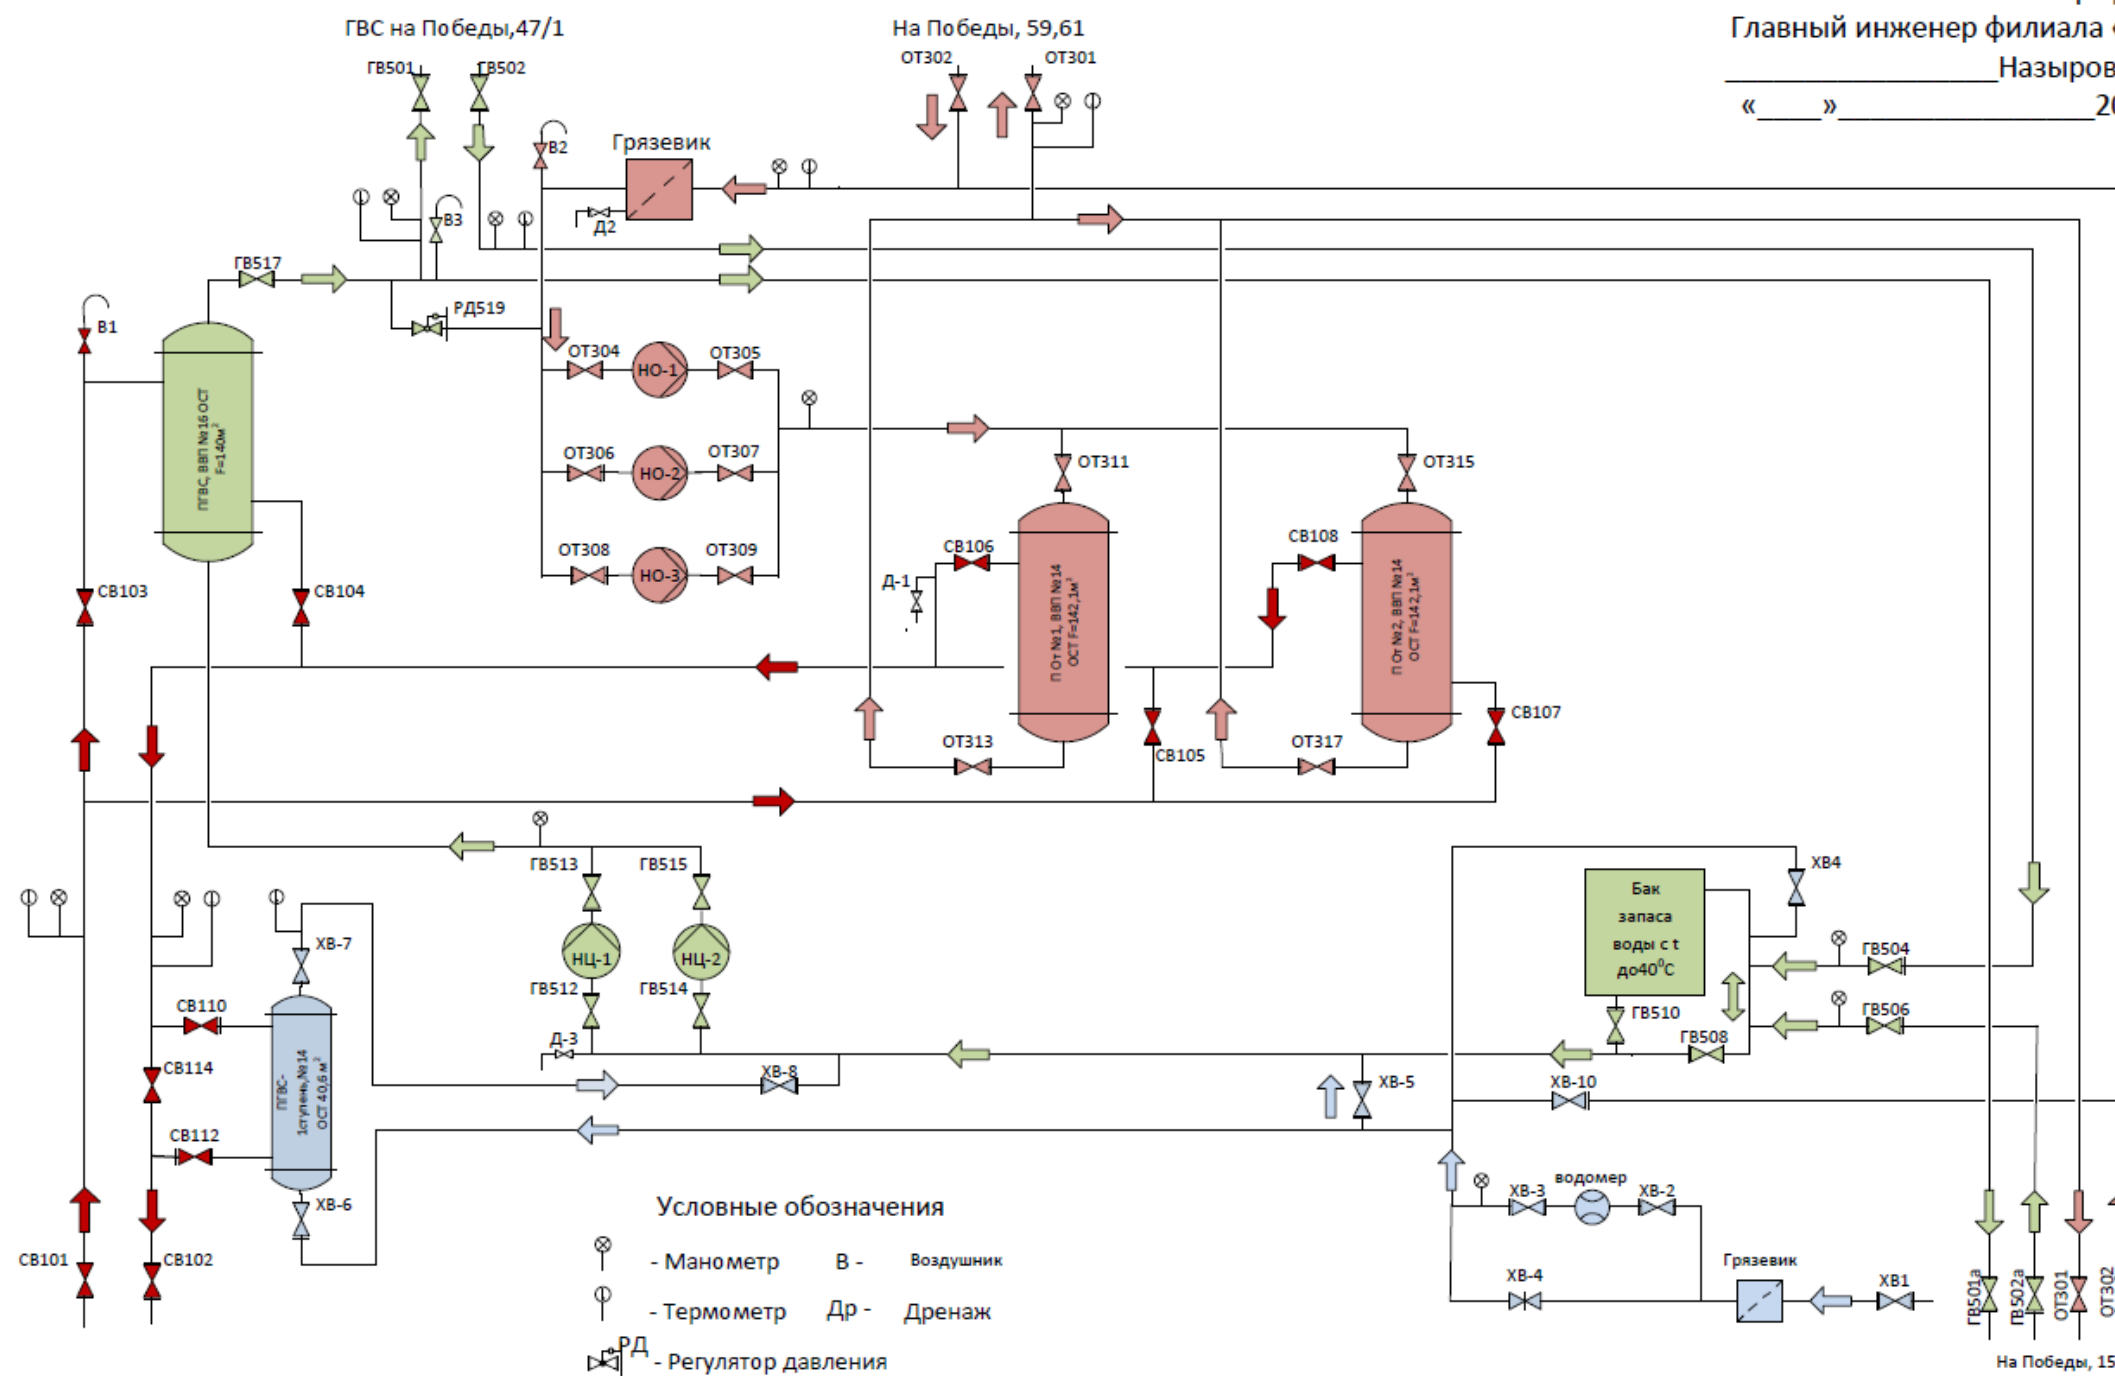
Модульный автоматизированный ЦТП-106 квартала
